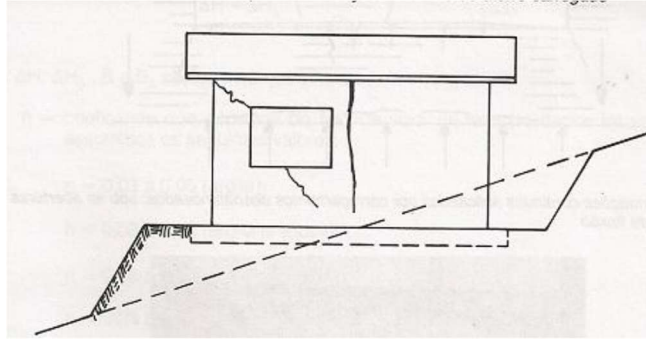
Exemplos de rachaduras encontradas nas unidades
